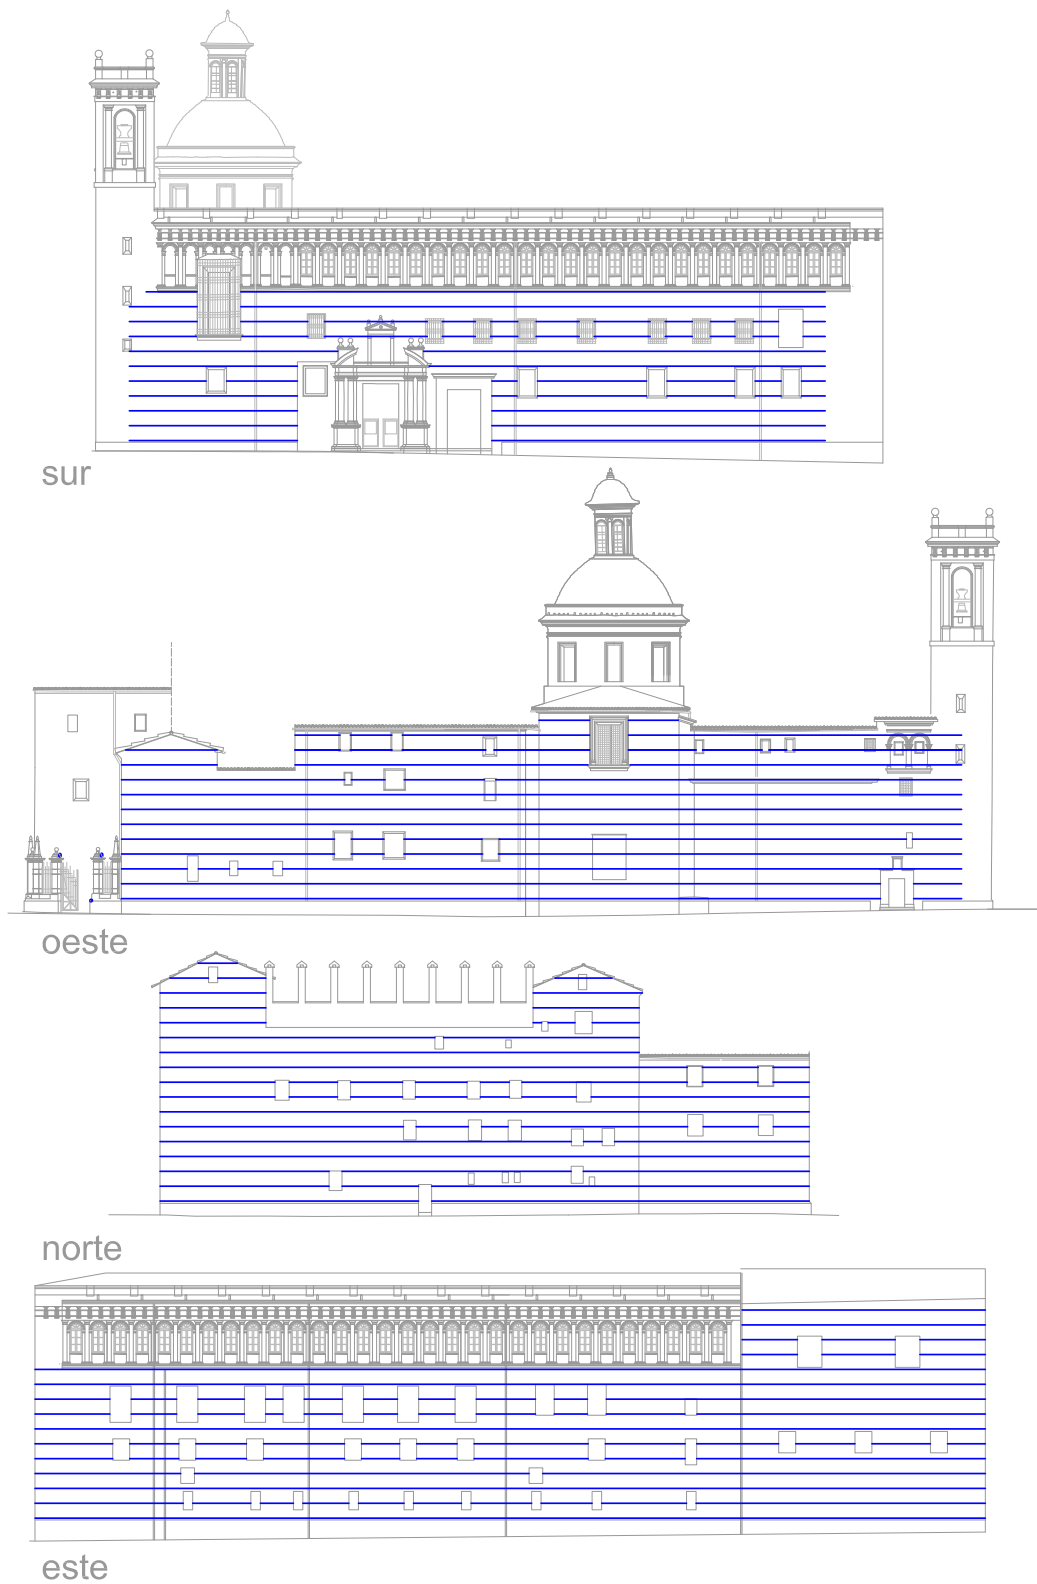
Vista general de las hiladas de tapial que componen el edificio.
